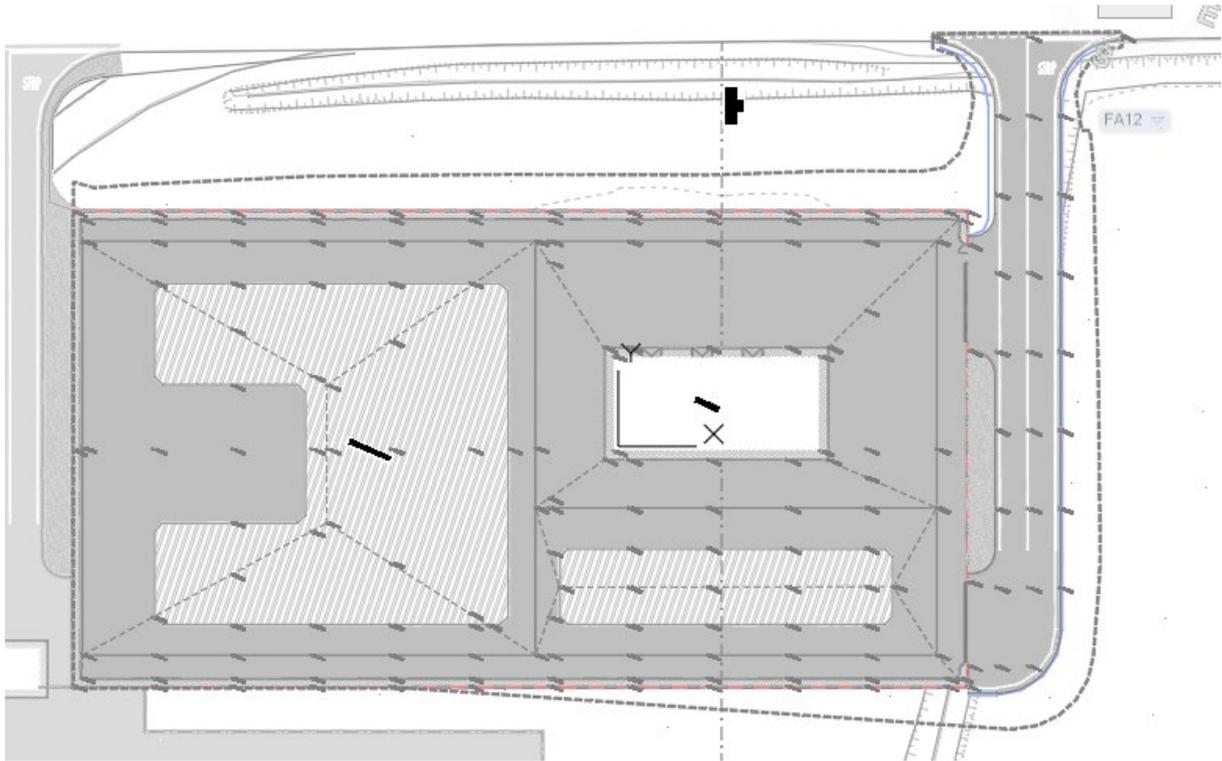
Estratto planimetrico dello stato di progetto – Individuazione dell’area oggetto di intervento con polilinea tratteggiata nera.
